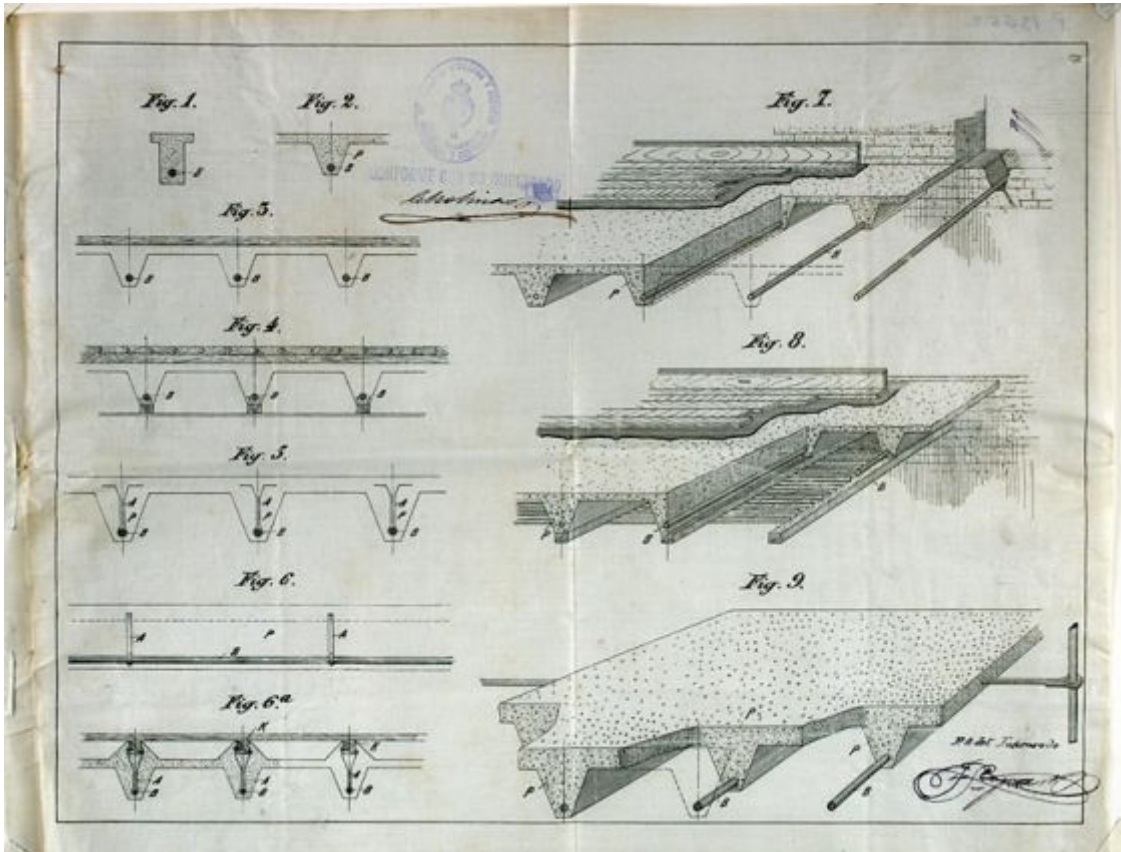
Patente española del Sistema Hennebique de hormigón armado, 1892. CEHOPU
